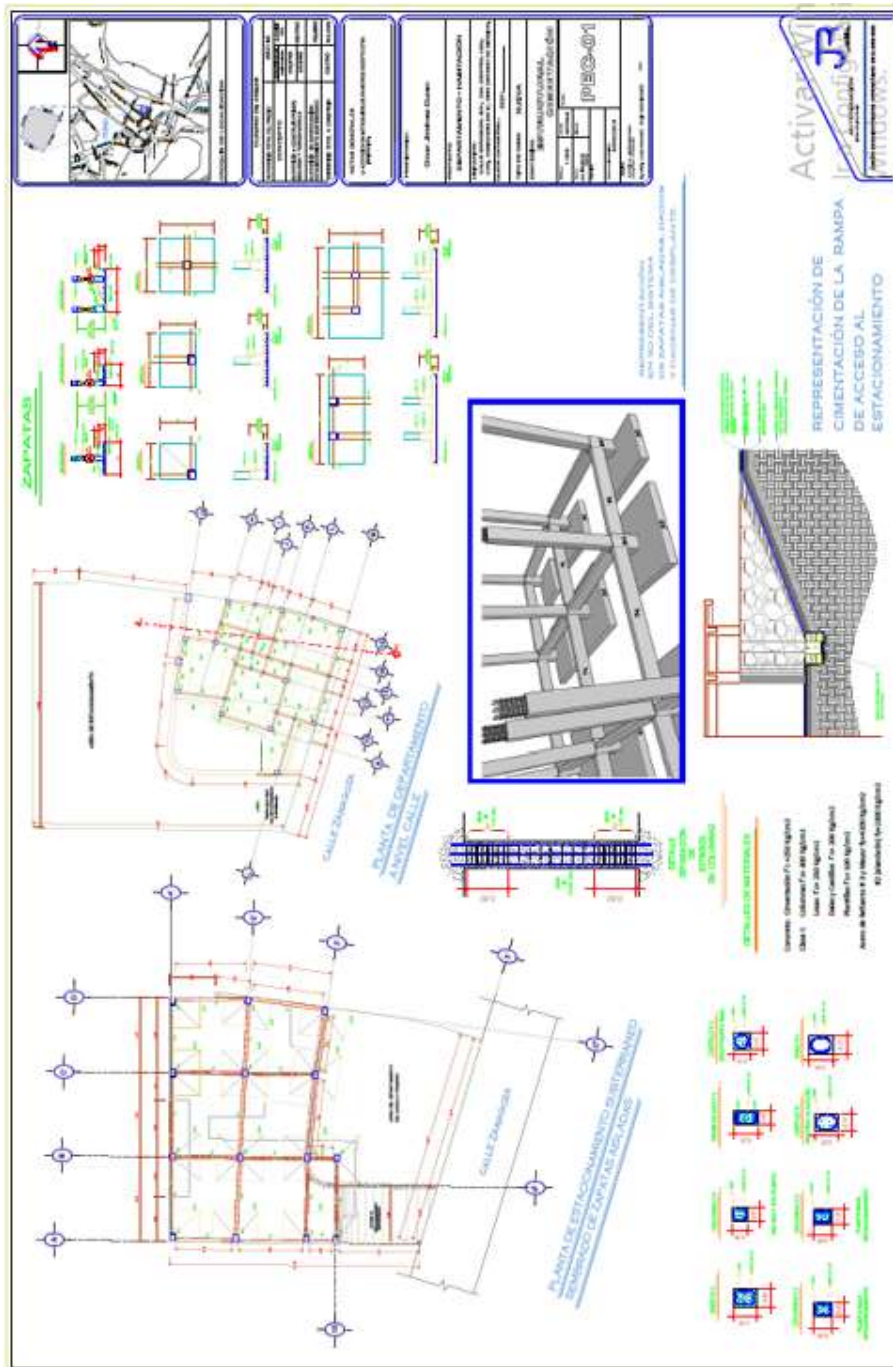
Imagen del plano de Cimentación y Desplante, donde se especifica la propuesta del tipo de cimentación, así como la simbología de ello, las plantas que conforman la cimentación, tanto en el estacionamiento subterráneo, como del primer módulo de los departamentos. La propuesta de columnas por utilizar y su configuración de armado, así como el corte de la rampa de acceso, de la calle al estacionamiento y el detalle en 3D de las columnas, dalas de desplante como las zapatas intermedias y esquineras.
